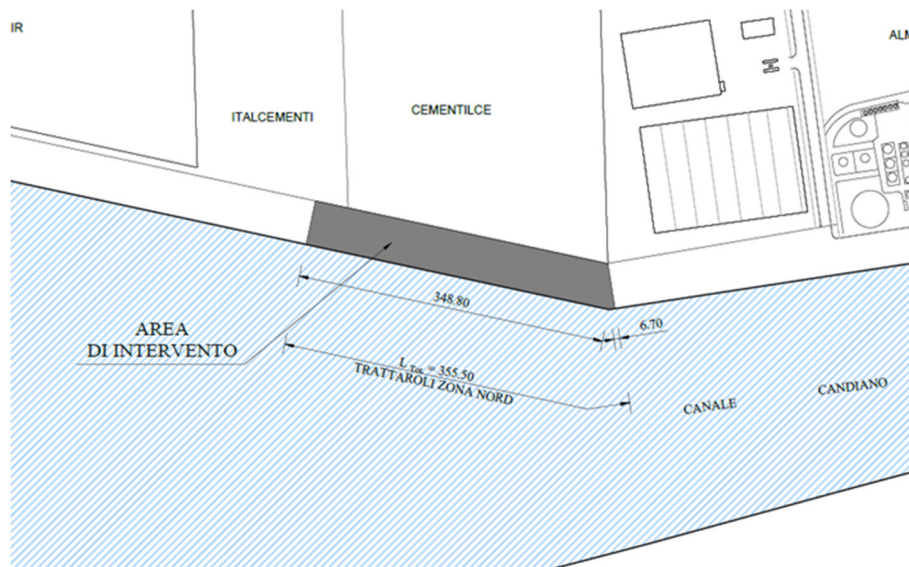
planimetria della banchina Cementilce Trattaroli Nord (Banchina “D”)
